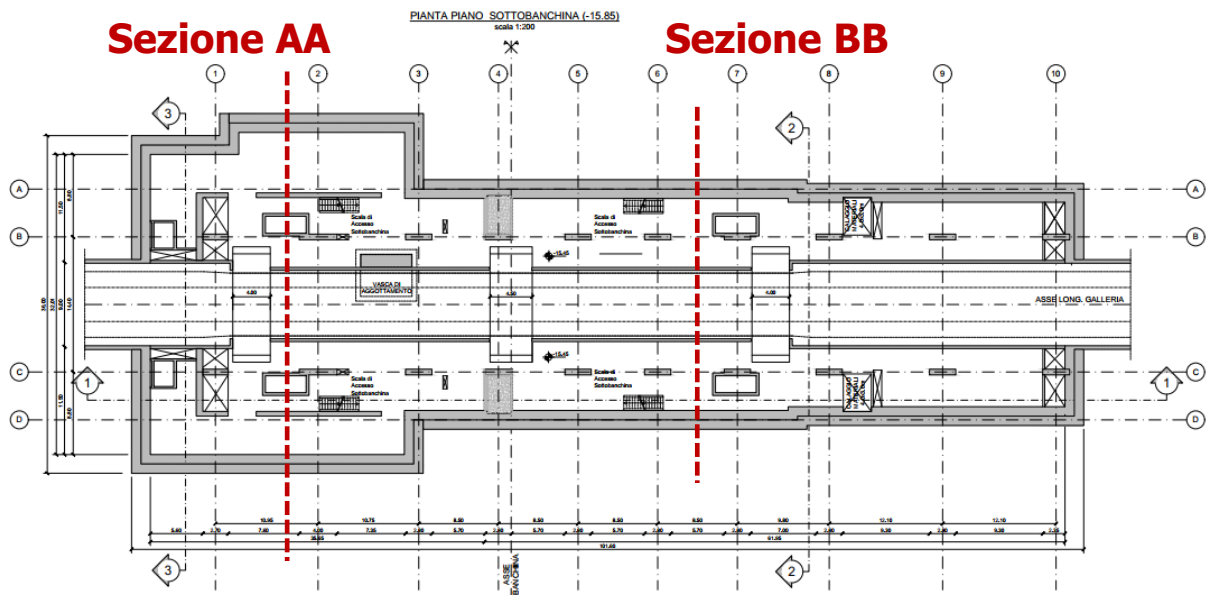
Stralcio planimetria stazione Rebaudengo con indicazione delle sezioni di calcolo
